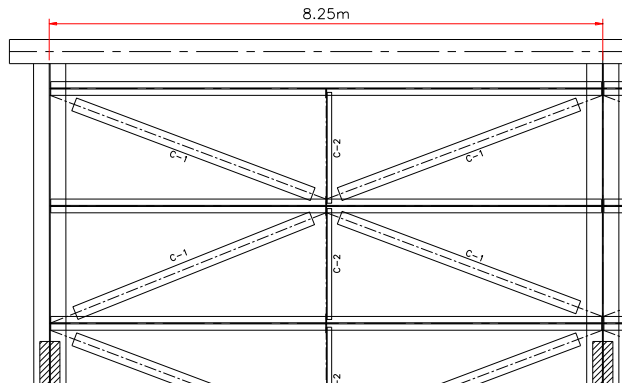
Vista en planta de tramo carretero adyacente a la pasarela peatonal, se observa la longitud libre de pandeo de los largueros.
